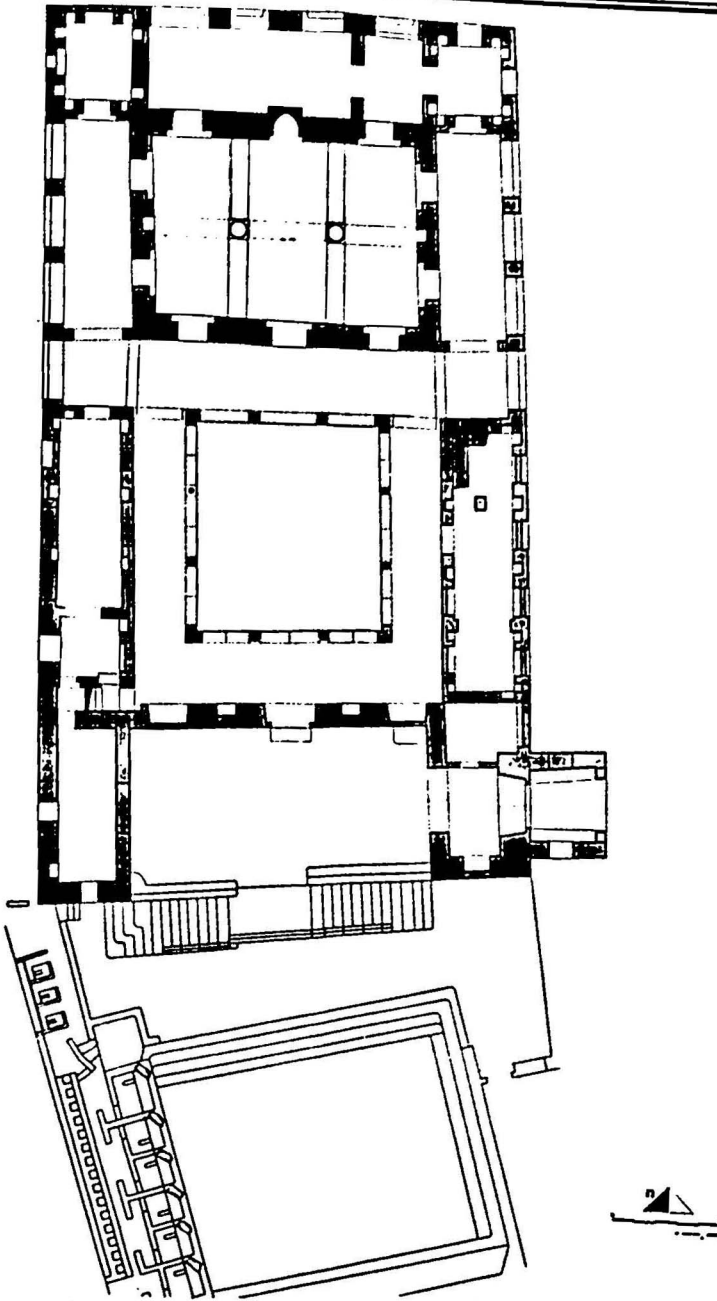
مسقط أفقي للمدرسة المستنصرية ببغداد
